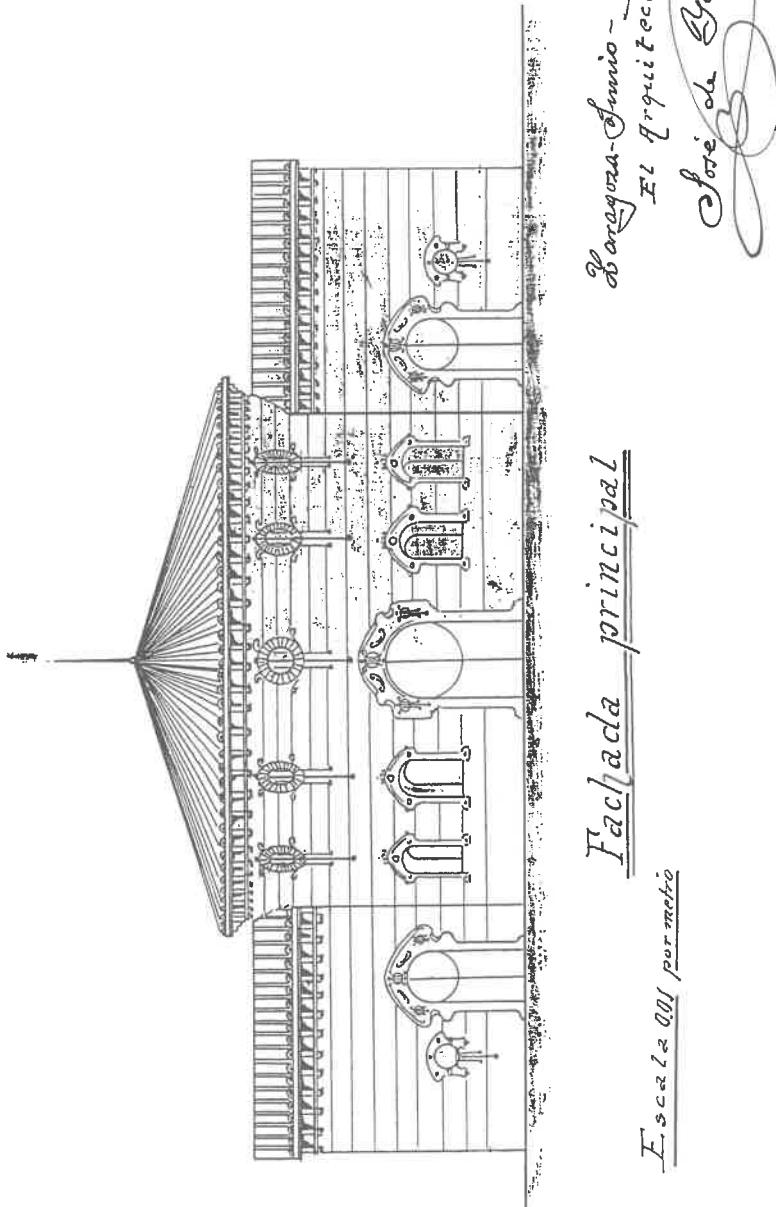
Plano con el alzado de la fachada principal del teatro de Alcañiz proyectado por José de Yarza (1906), conservado en el archivo privado de su familia.
